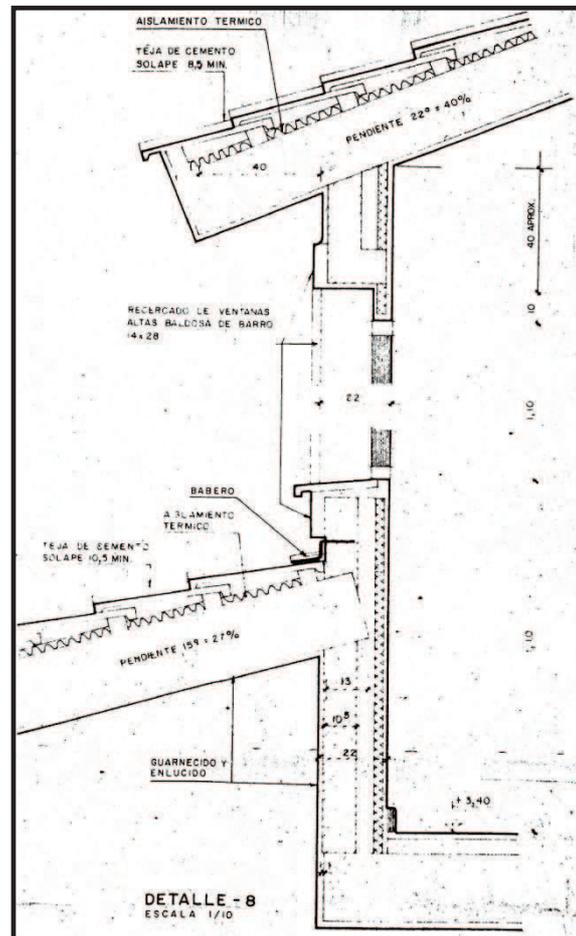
Detalle de cubierta y encuentros con cerramiento exterior. Extracción del proyecto original, archivo de Mairena del Aljarafe.
